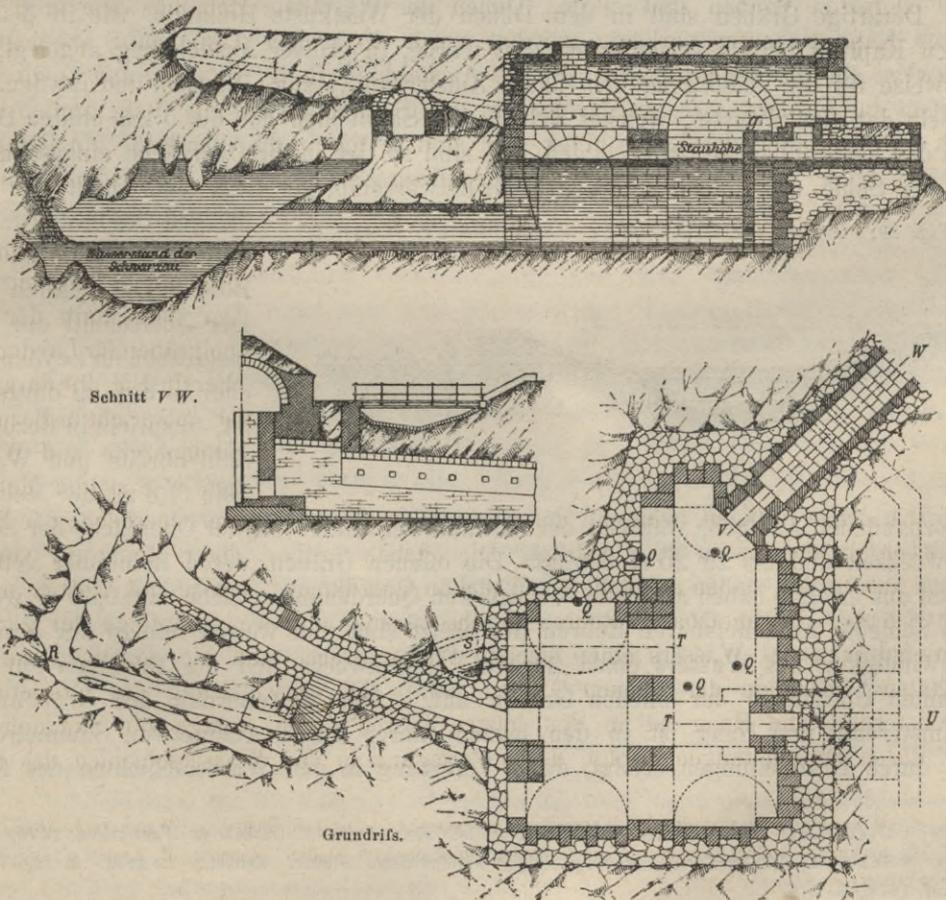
Wasserschloß Kaiserbrunn. M. 1:400.
